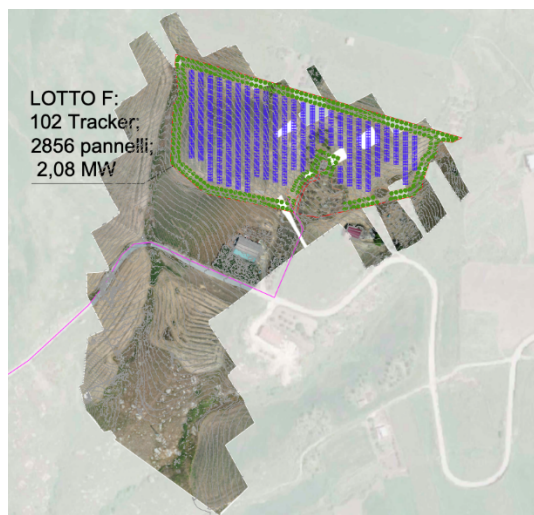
Particolare Layout di impianto area F su stralcio rilievo
